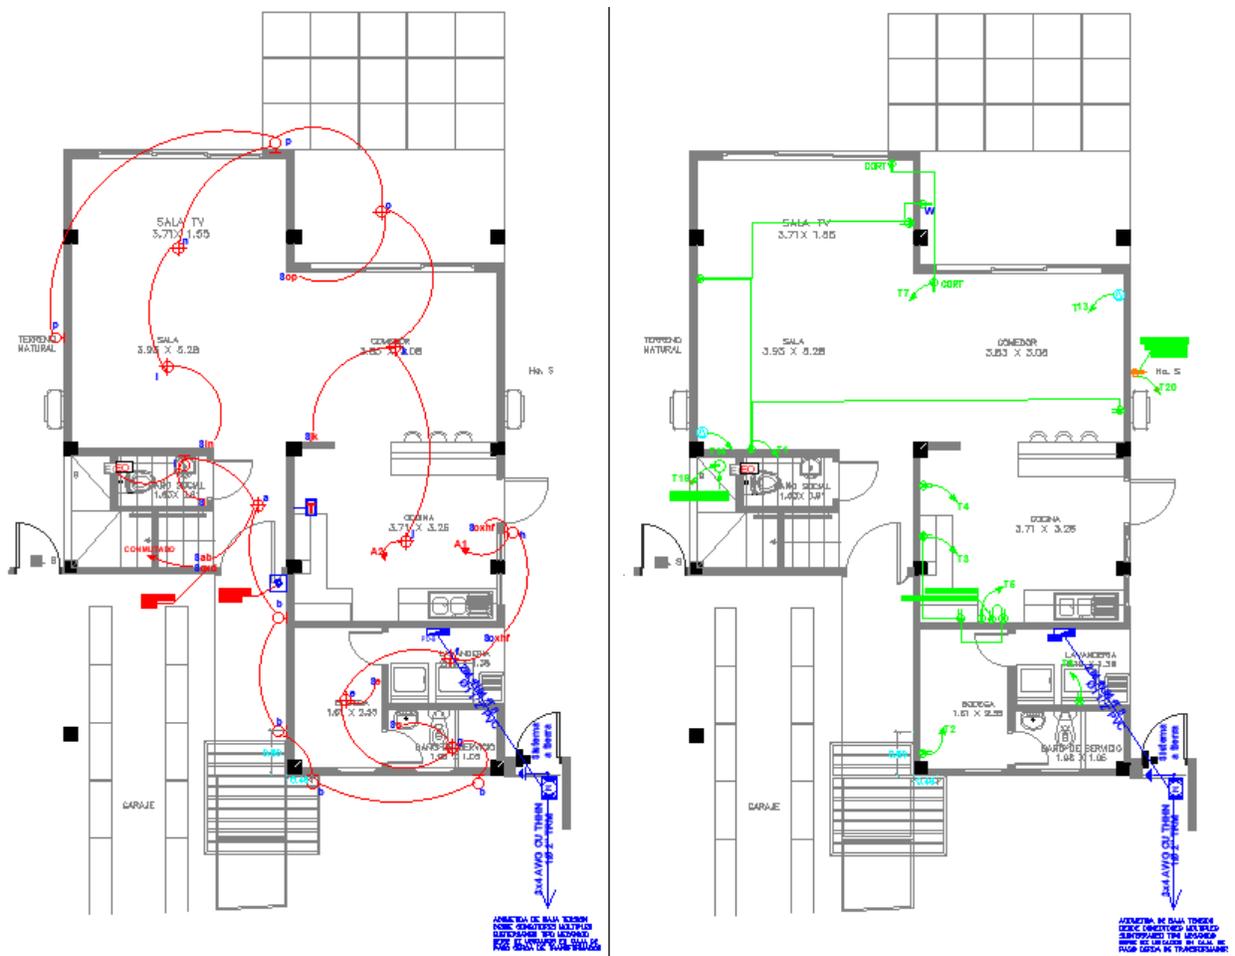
Plano de tomacorriente y alumbrado en planta alta en AutoCAD. (Inmovila 2023)
